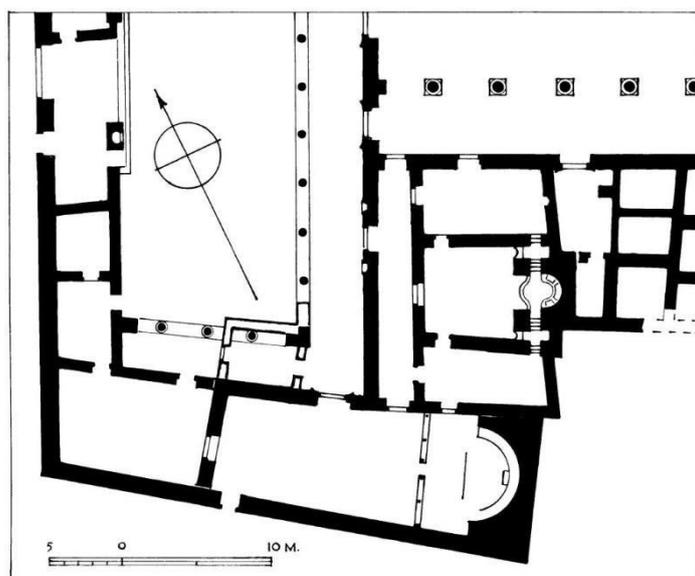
Battistero di Gerasa (particolare della pianta da PICCIRILLO 1989).
